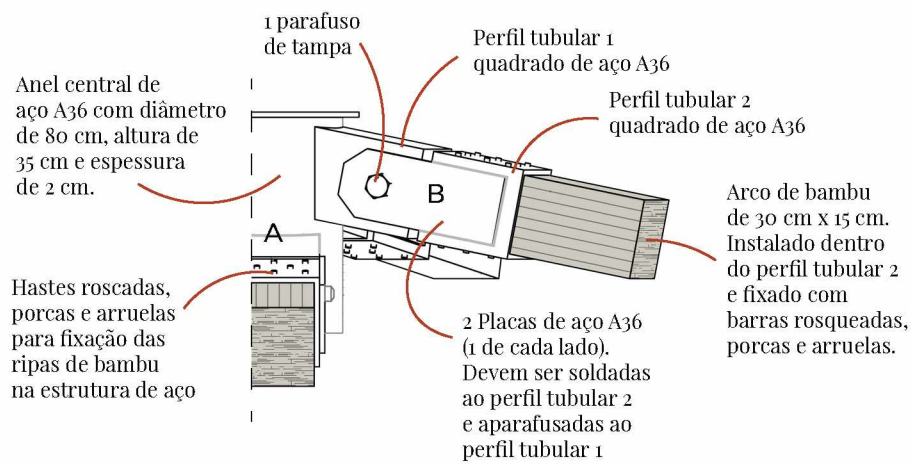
Detalhe Anel Estrutural - perspectiva. Sem Escala. Fonte: Elaborado pela autora.
